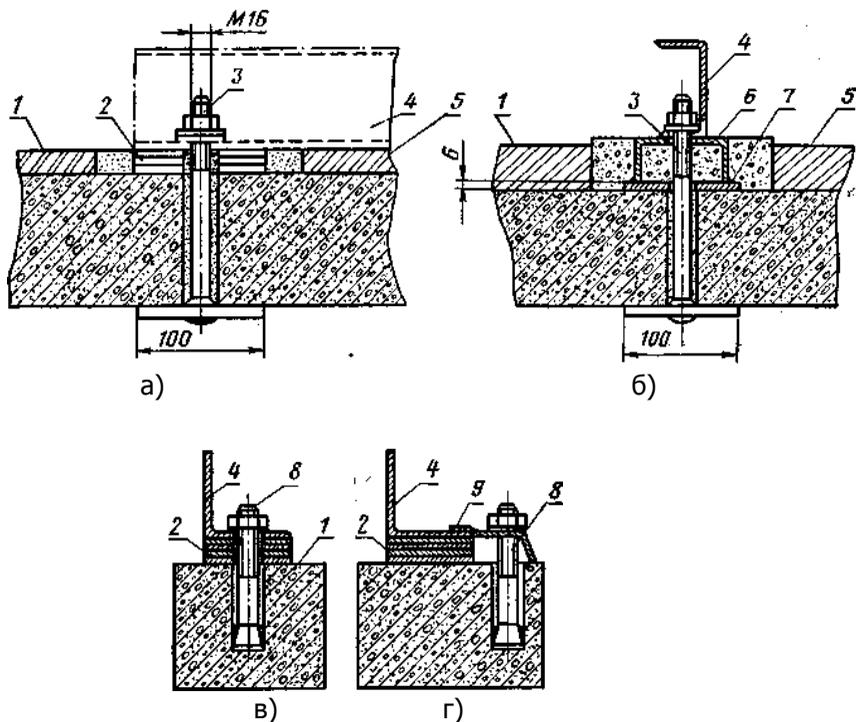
Варианты установки и крепления машин к межэтажным перекрытиям:
